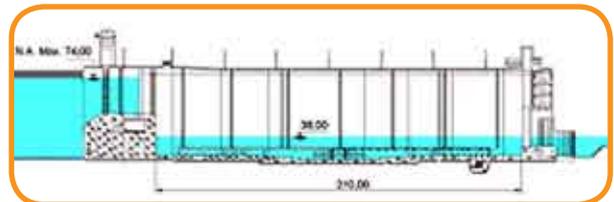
Corte Longitudinal Esquemático da Eclusa I, onde podem ser vistos os níveis d'água e o comprimento da câmara.
